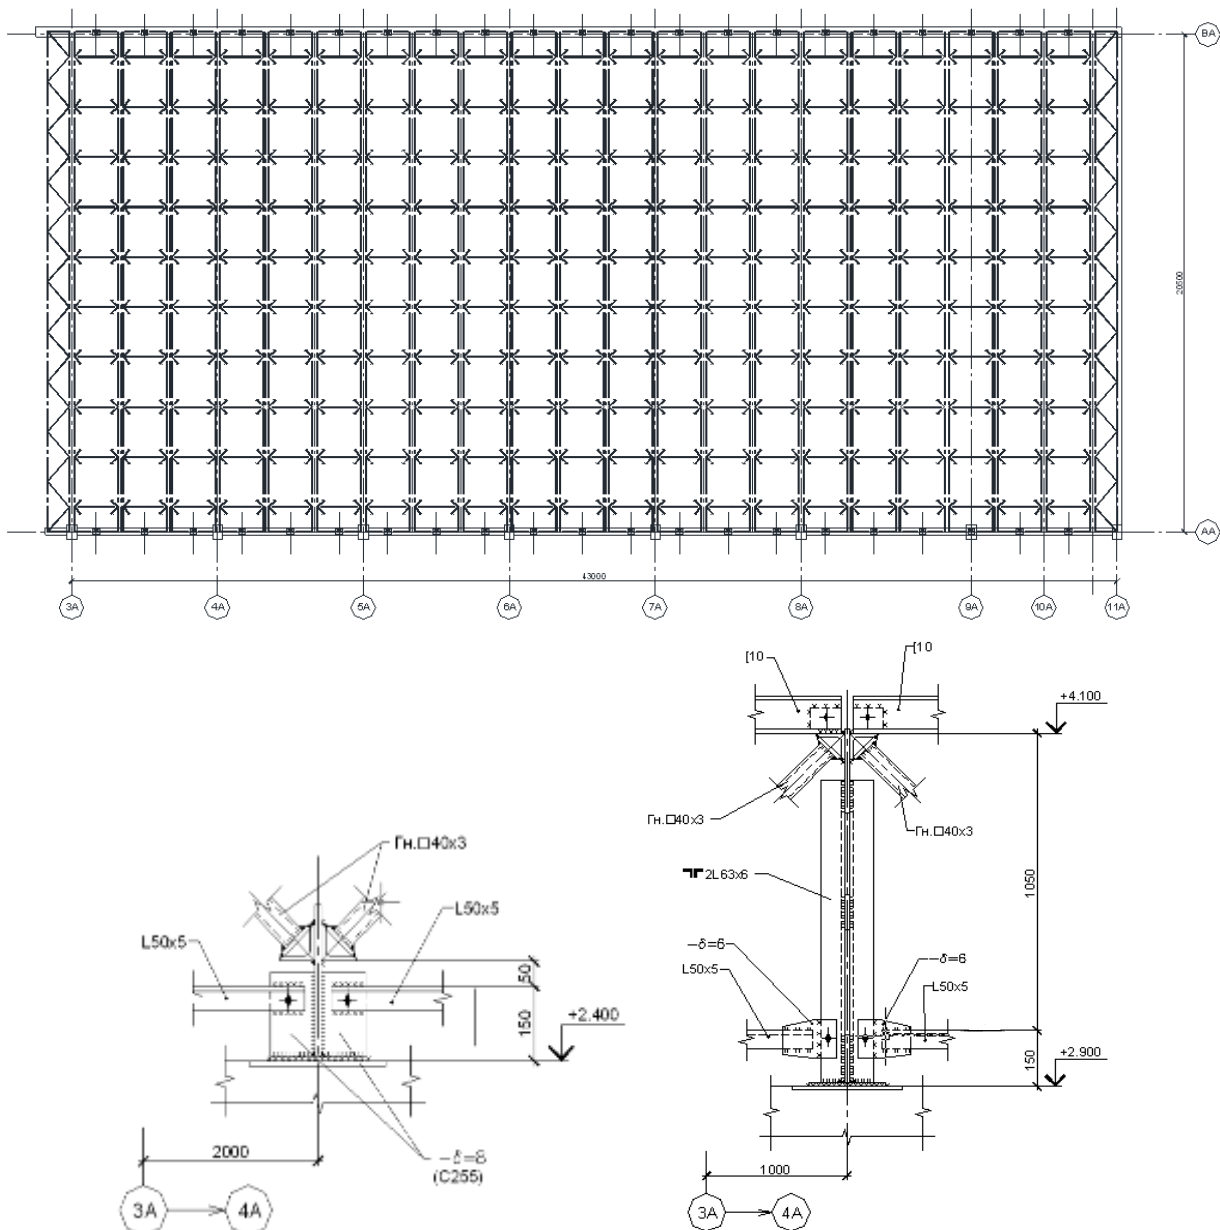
Компонка перекрытия. Схема перекрытия. Сечения.
